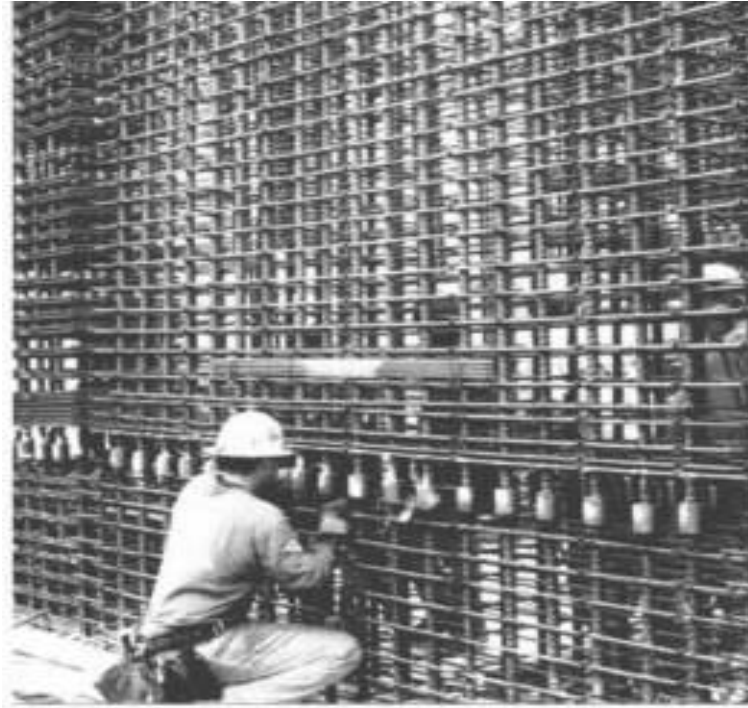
柱格网钢筋笼构件受力筋与下层钢筋的连接
